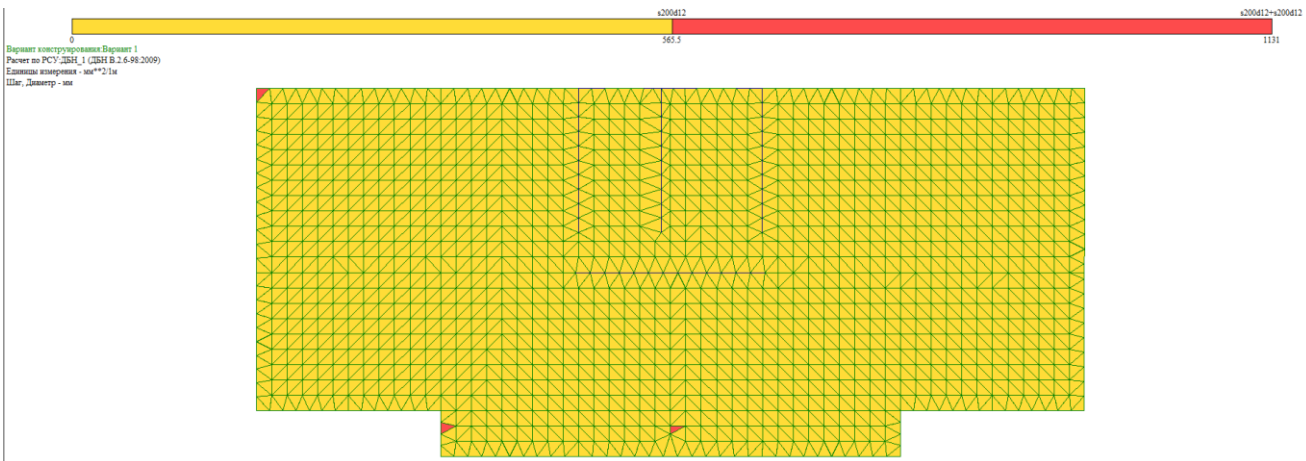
Площа арматури на 1 м.п. по осі у (верхня грань)
